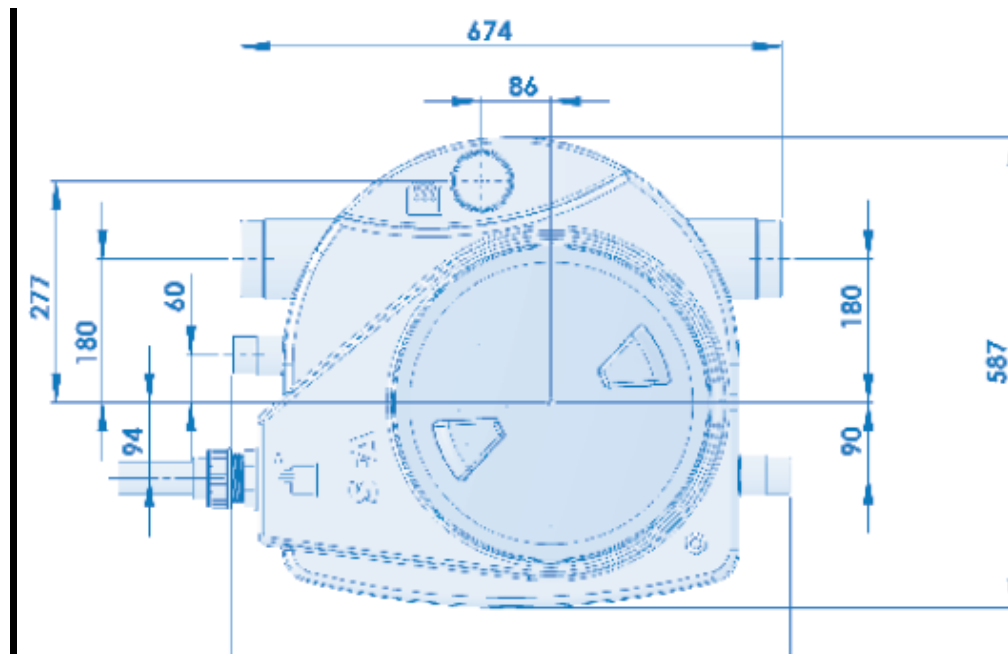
Vista Lateral da Estação Elevatória Sanifos 110
